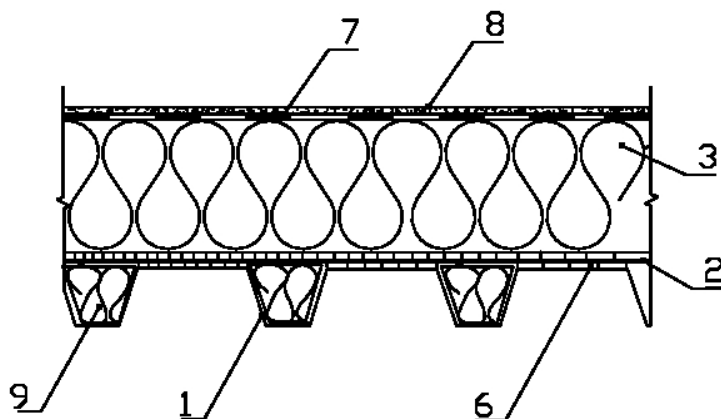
Кровля из стального профилированного листа с теплоизоляционным слоем из плит ИЗОРОК по несущему стальному профилированному настилу.
